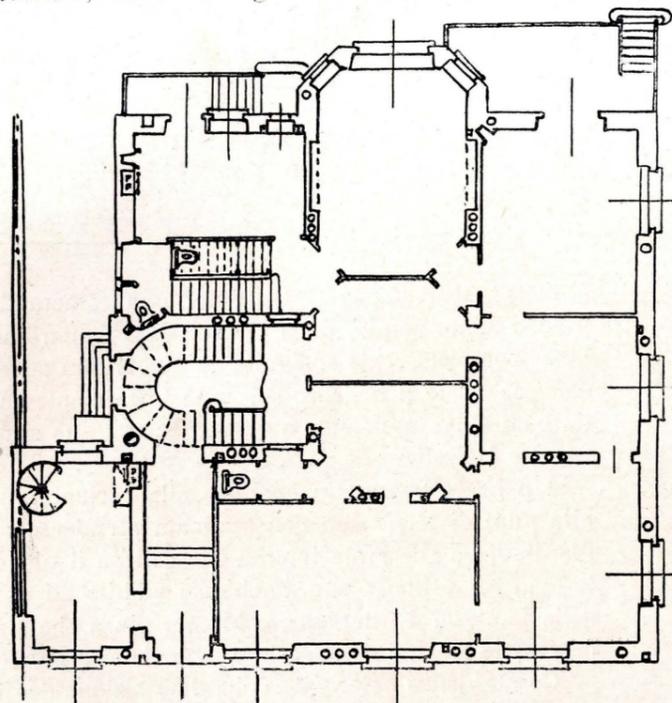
Palazzina Momo - Pianta piano terreno.
